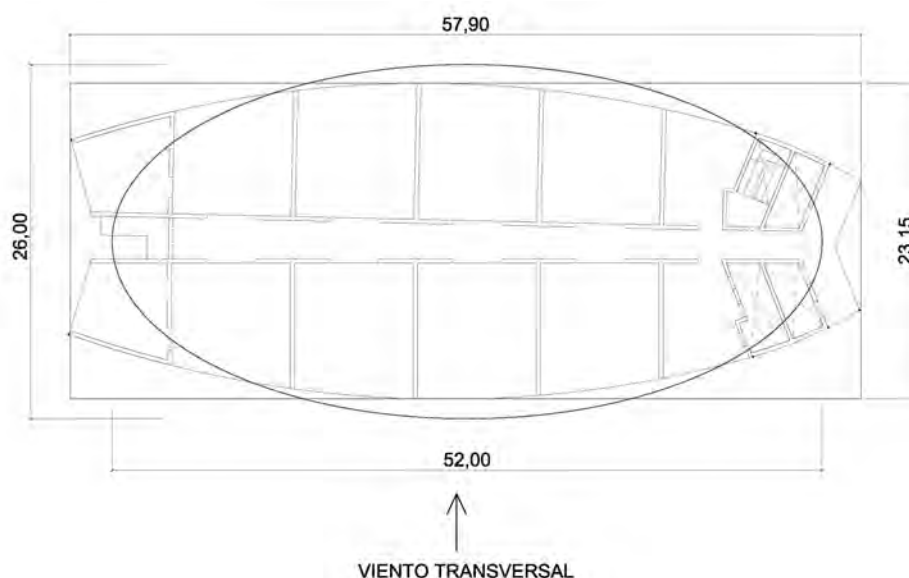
Simplificación de una planta a una sección rectangular y a una elíptica.
